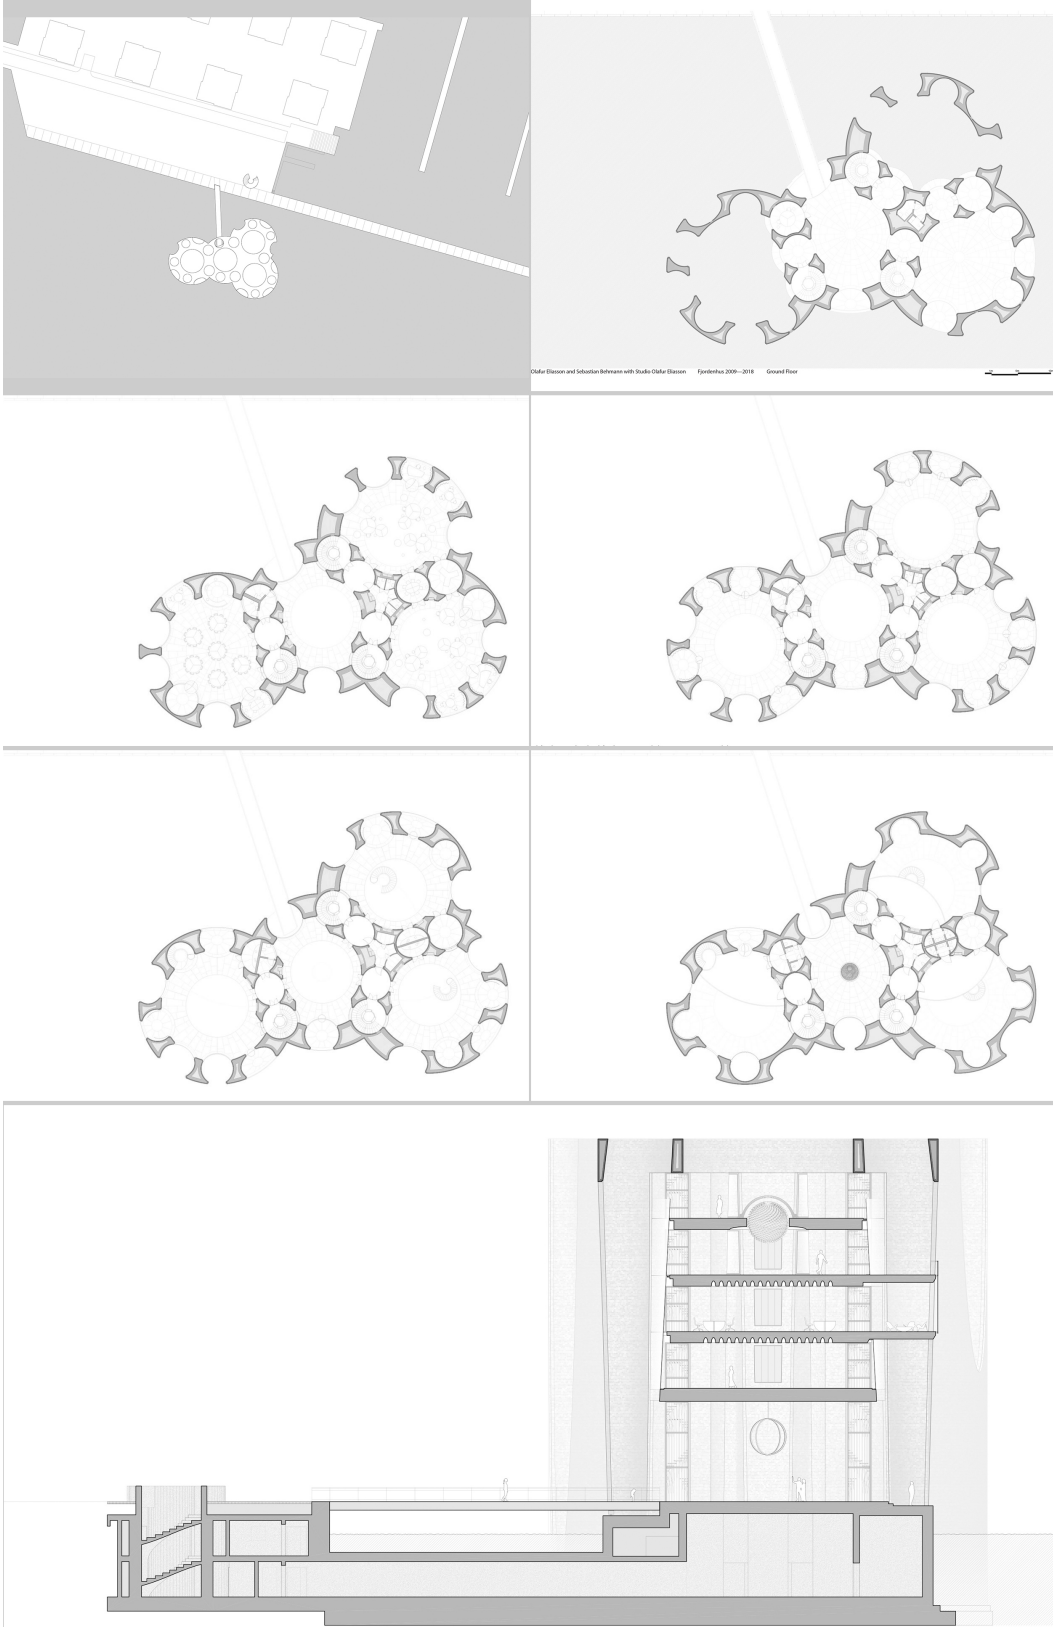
Fjordenhus* plantas de distribución arquitectónica y sección.
